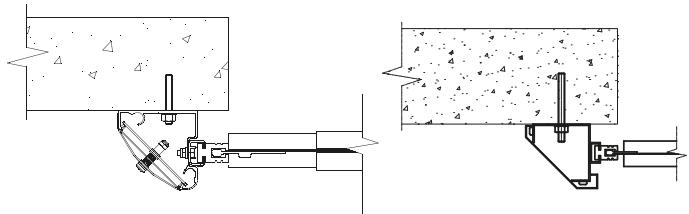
Fijación en estructura de ALBAÑILERÍA
